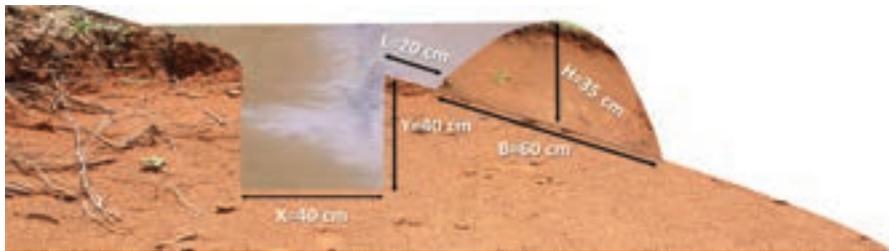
Dimensiones recomendadas de la zanja y el bordo.
